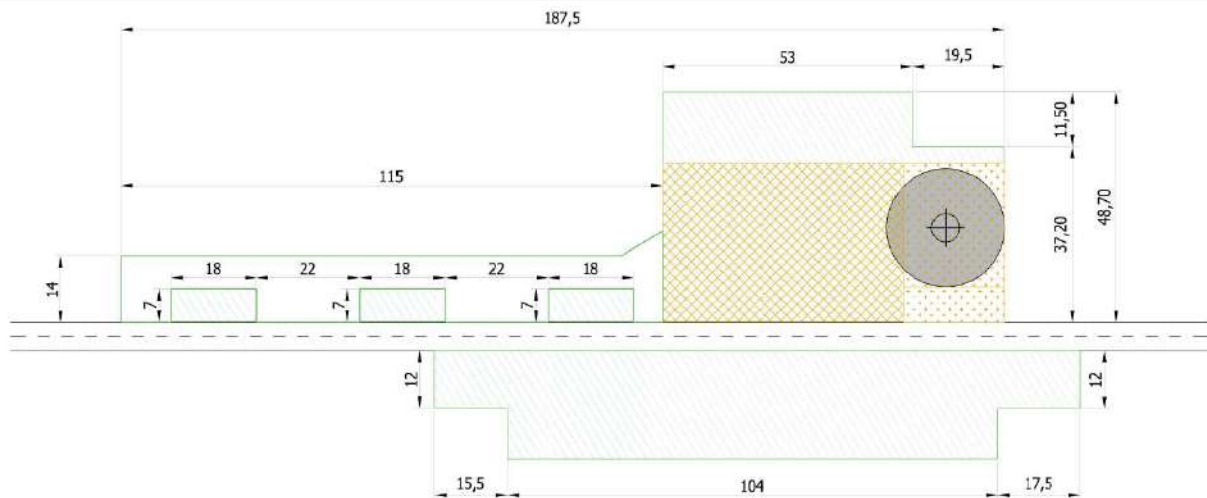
Individuazione delle aree di una piazzola tipo in fase di esercizio, vista dall'alto, da rinverdire (retino verde)
